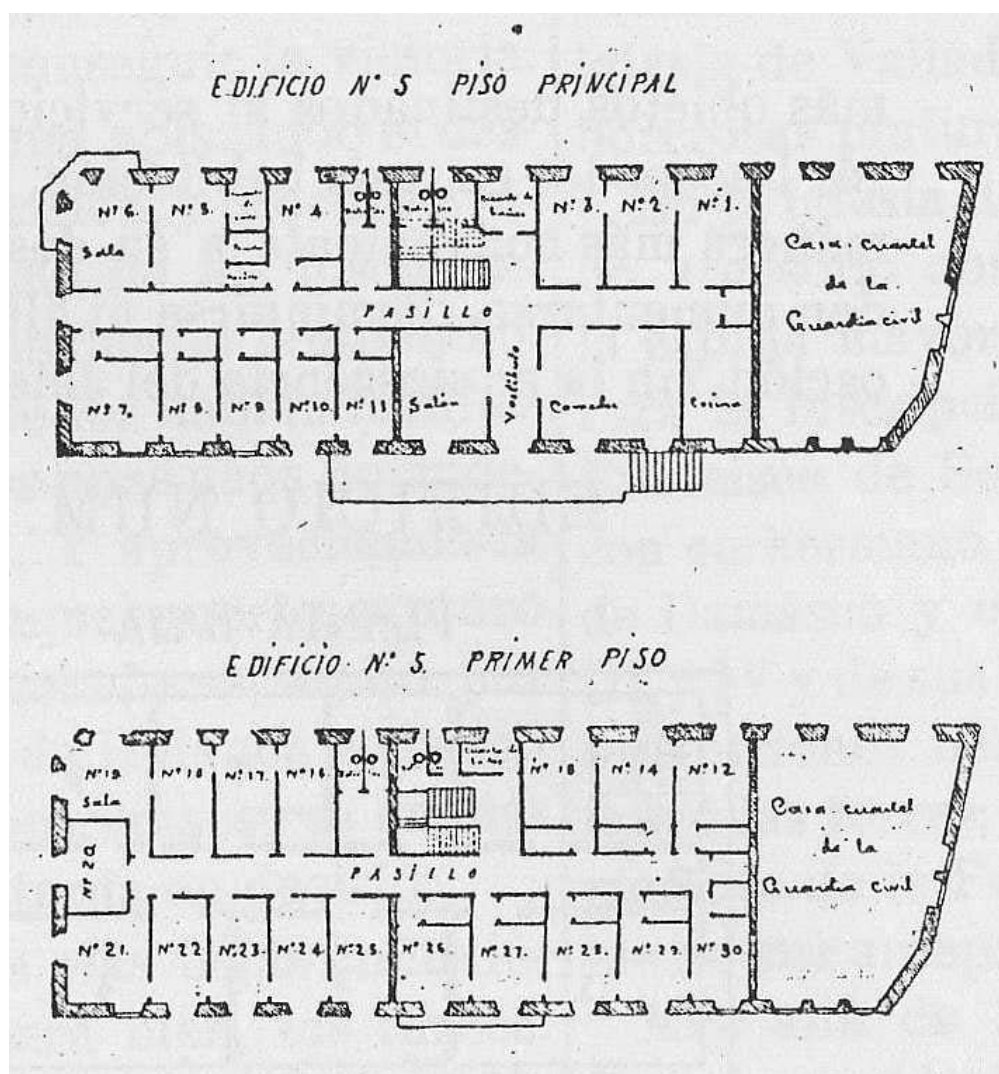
Plantas principal y primera del hotel n° 5. [La Temporada 1912 n° 14]
